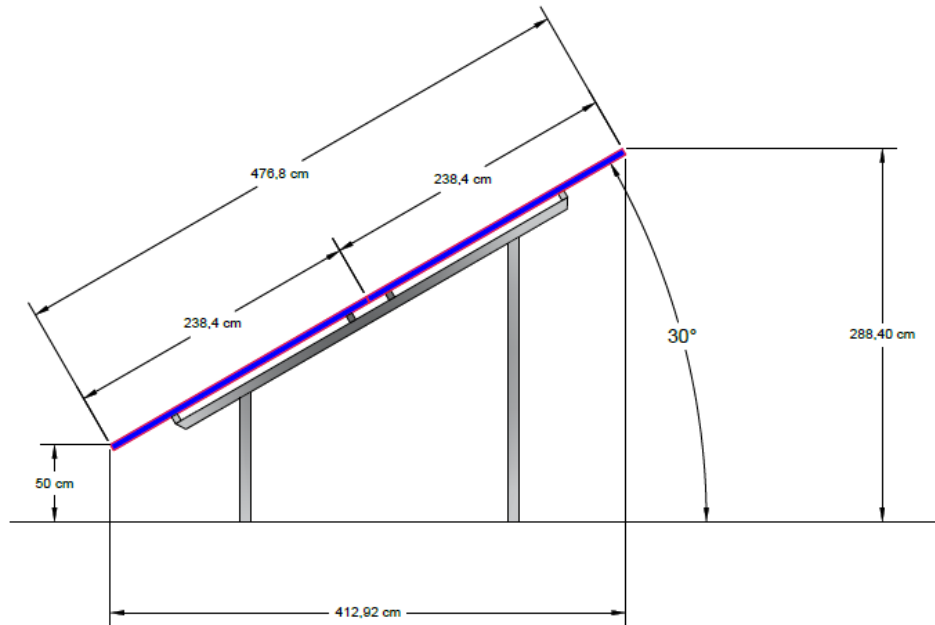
Technische Zeichnung - Quelle: Auftraggeber
